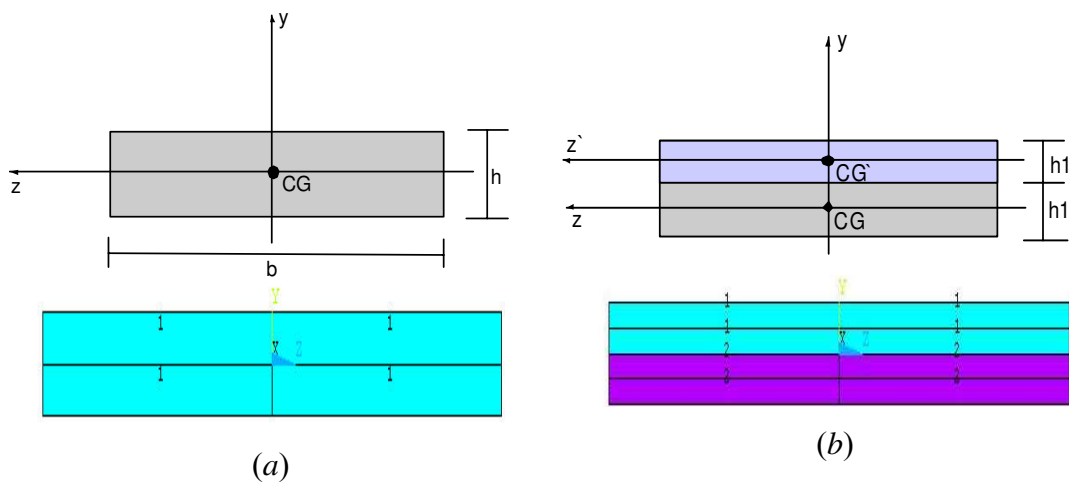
Seções transversais dos elementos de vigas: (a) viga de referência, (b) viga de teste.
